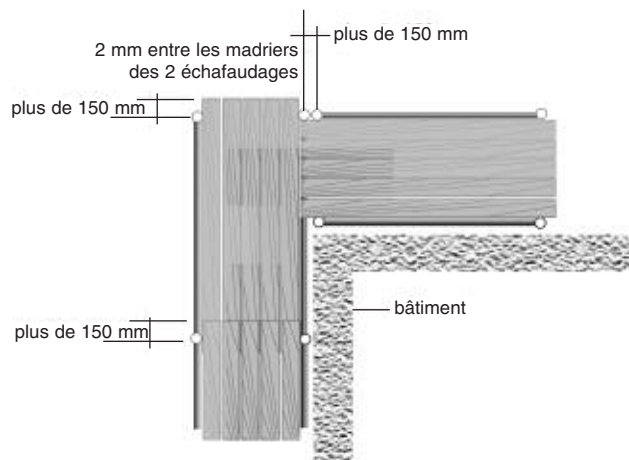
Installation de madriers sur des échafaudages placés en angle
